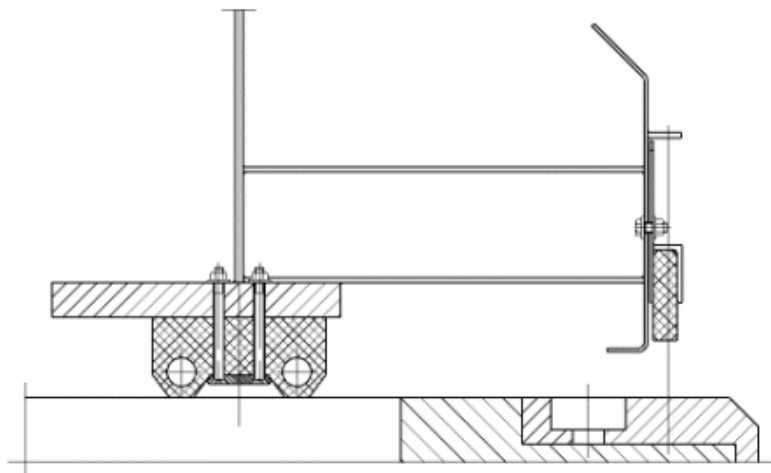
Dichtungssystem Tunnelwand/Betondrempel
